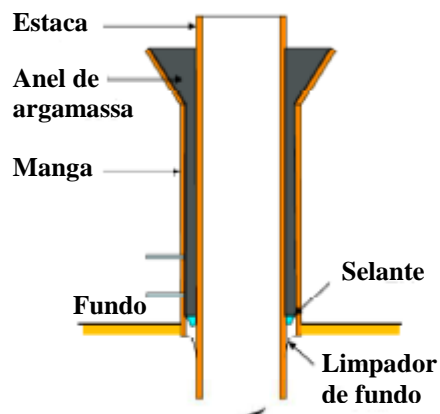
Ligação por *grouting*, adaptado [50]
